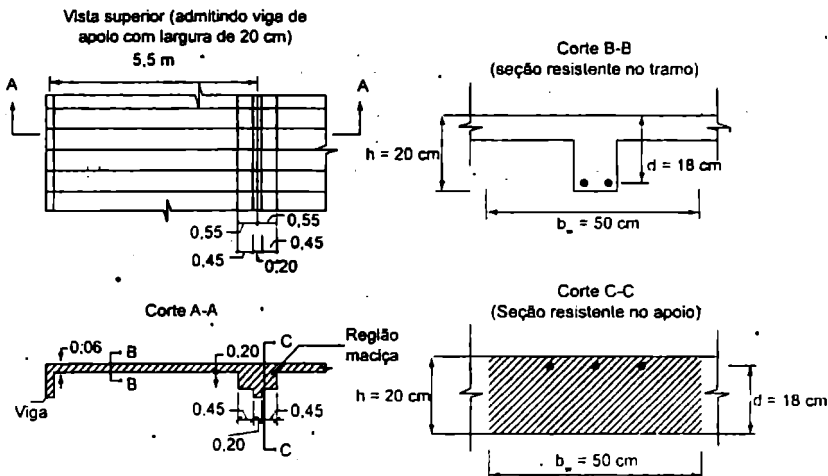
Esquema estrutural da laje com seção maciça próxima ao apoio central.
